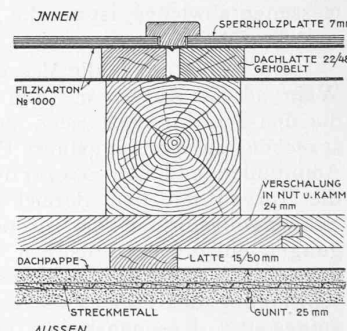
Horizontalschnitt durch die Aussenwand-Konstruktion. — Masstab 1 : 5.
